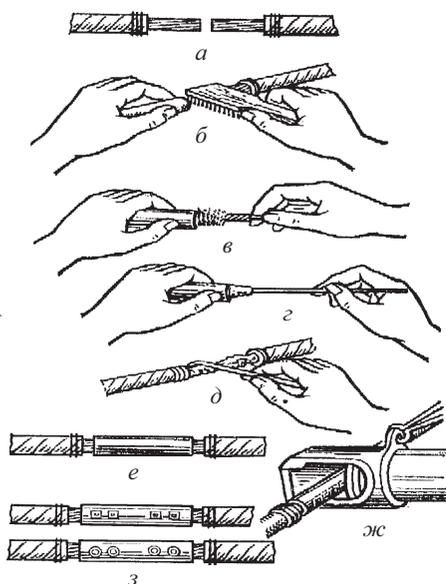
Опрессовка алюминиевых жил сечением 16–240 мм²:
